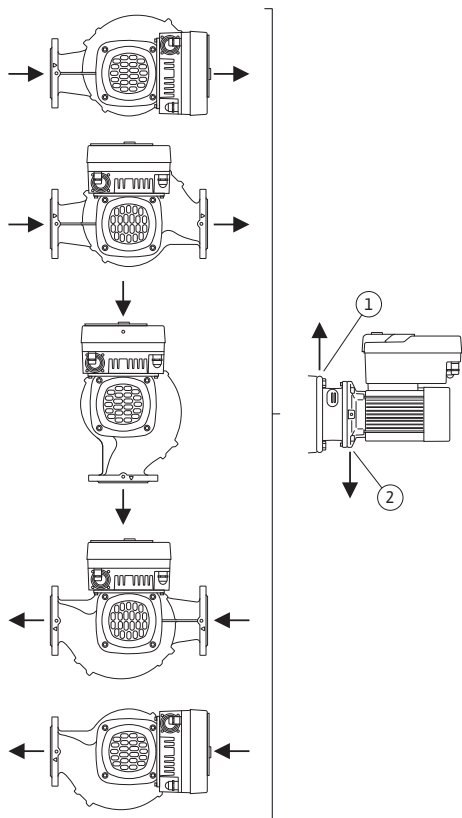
Posições de instalação autorizadas com o veio do motor na horizontal
